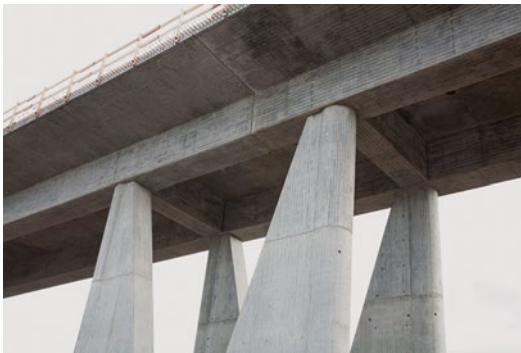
Vergleich Ausschreibung mit Alternativentwurf
